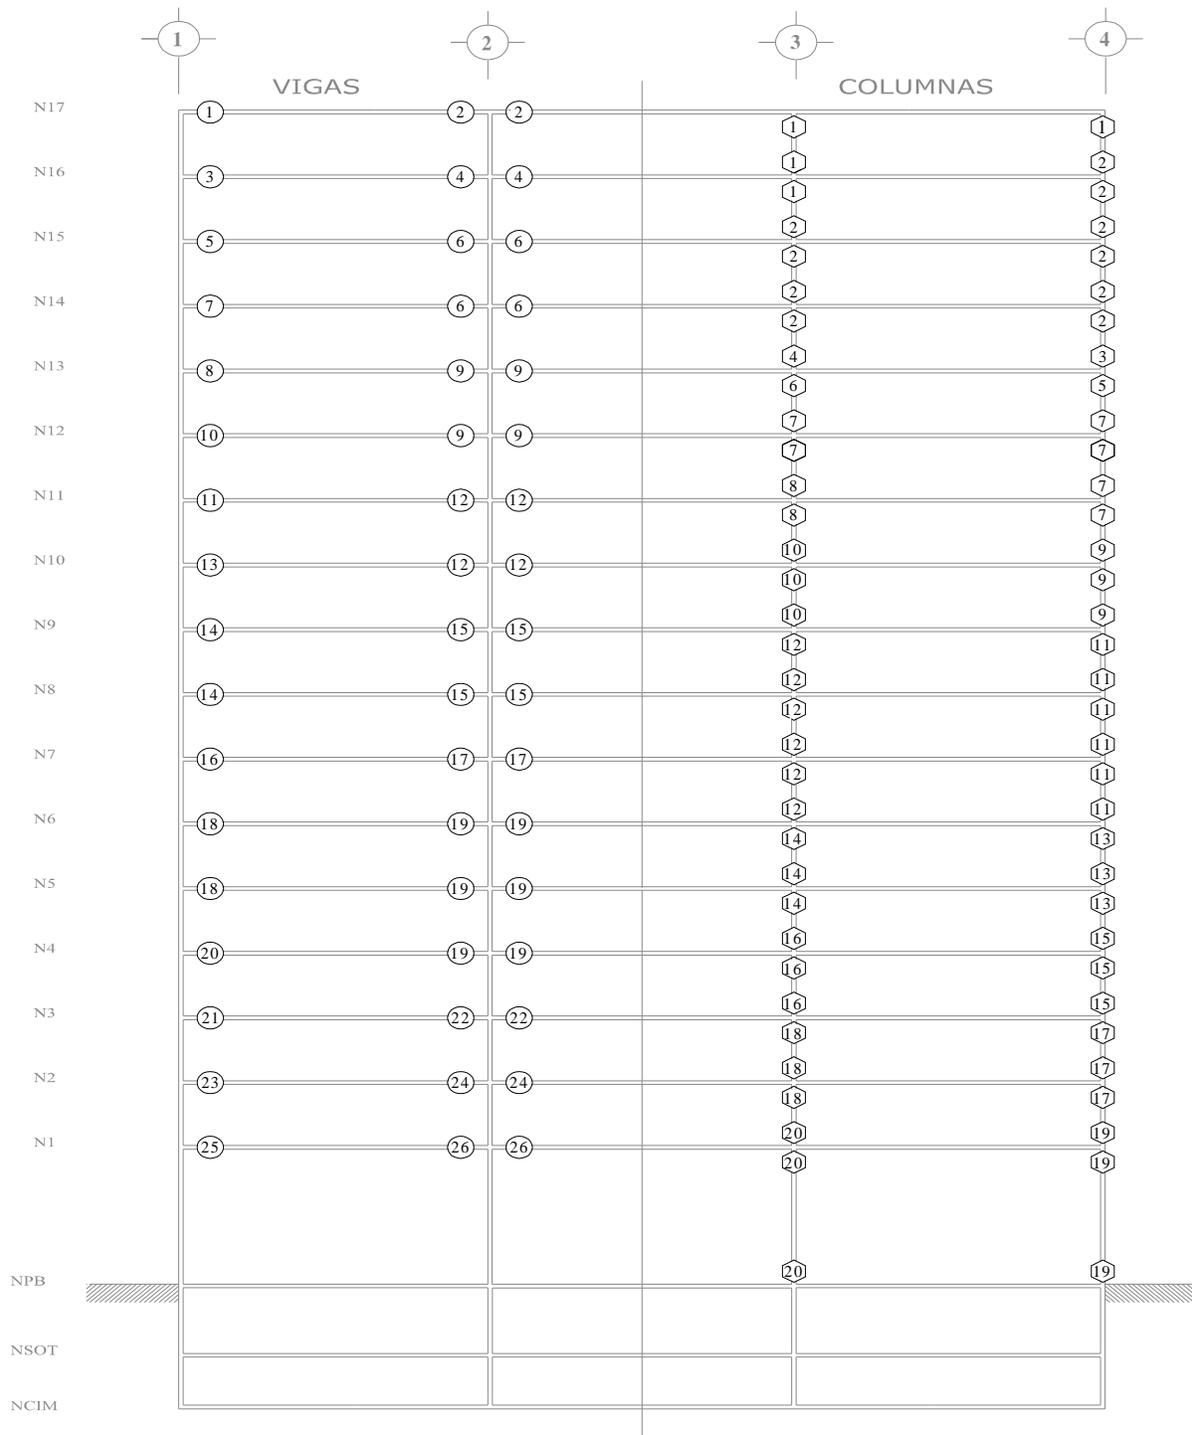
Ubicación de tipos de secciones de vigas y columnas del eje B, edificio 17 niveles, Cuerpo Principal
